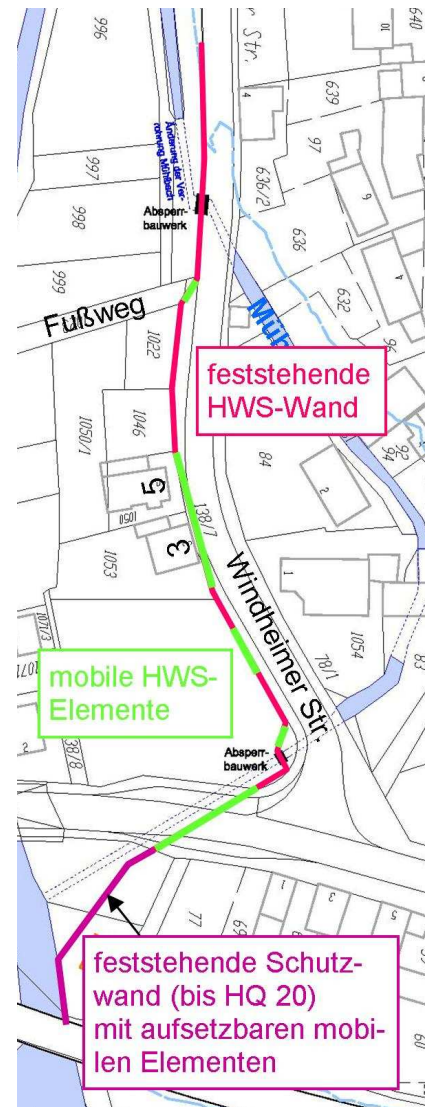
Grundriss Wand (feststehend und mobil)
